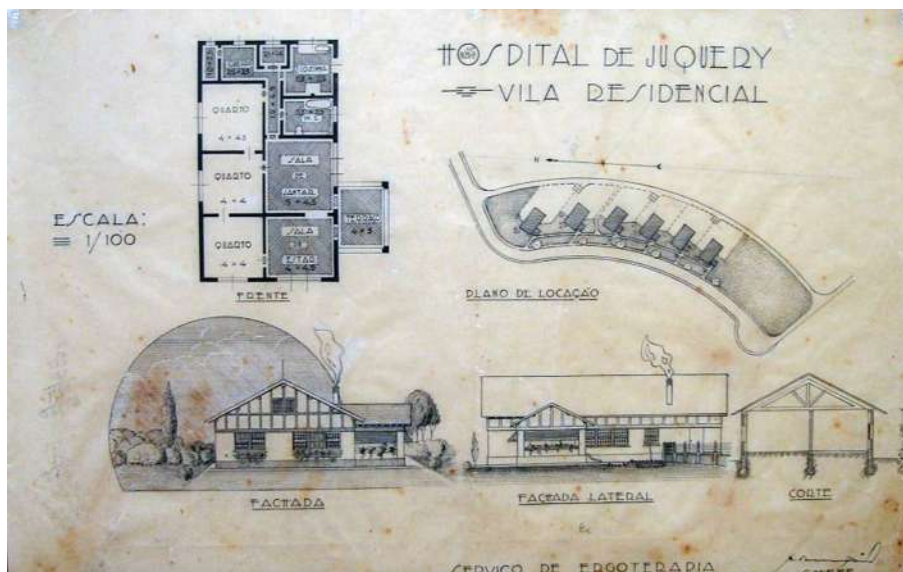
Fachada frontal, Fachada lateral e plantas da residência tipo da vila terapêutica (arquivo SIOC).
